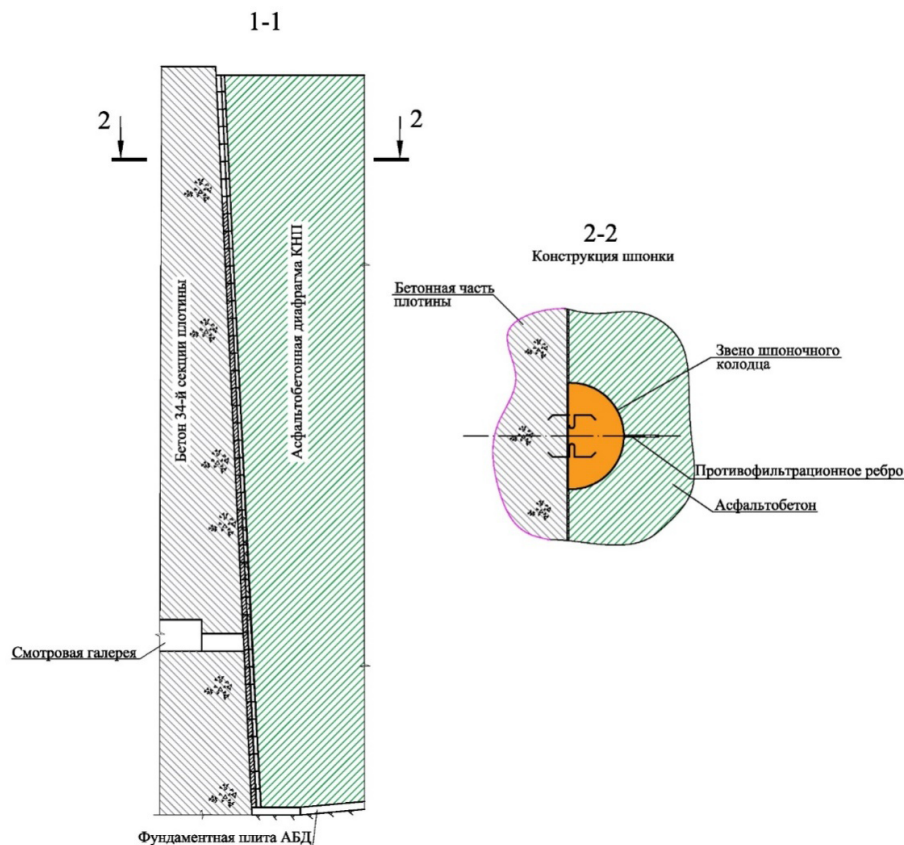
Конструкция примыкания асфальтобетонной диафрагмы к секции № 34 бетонной плотины
